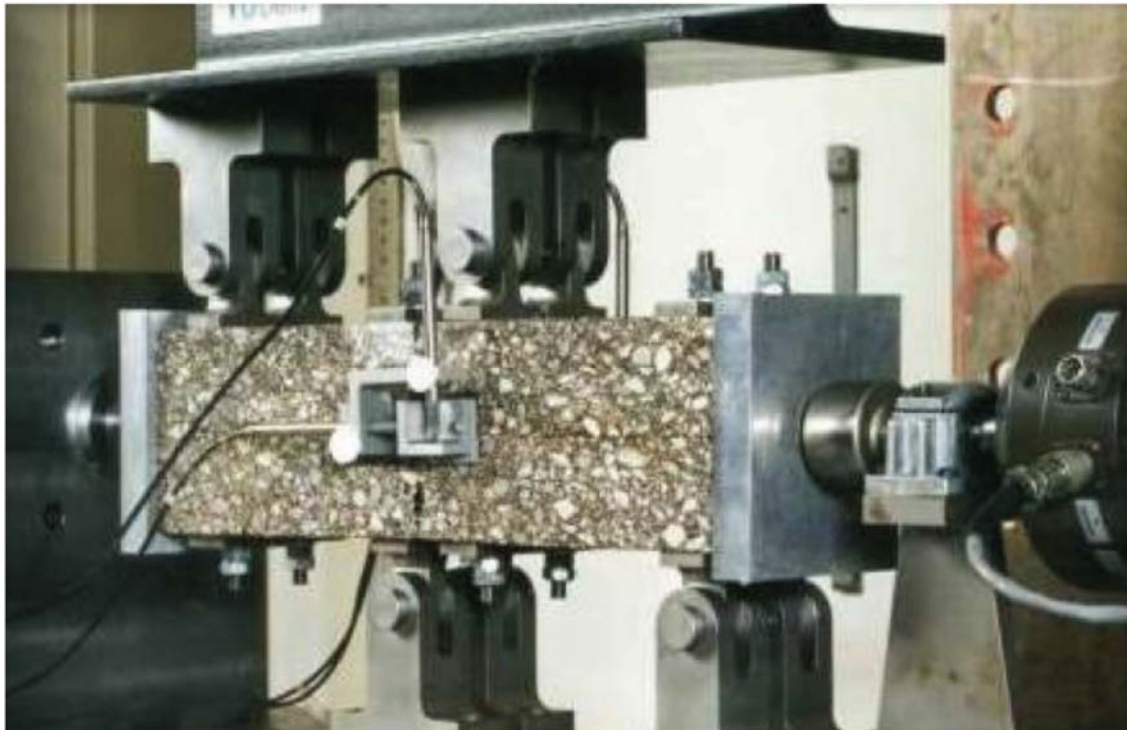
Ensaio de cisalhamento de viga de concreto asfáltico de quatro pontos (de BONDT, 2009)
